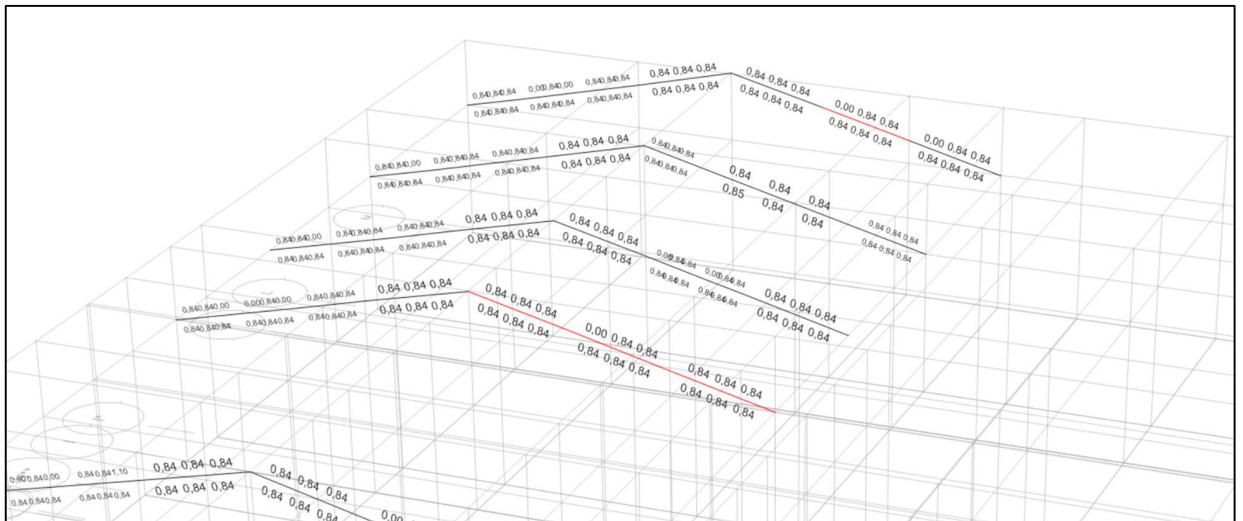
Secciones de vigas de cubierta (V1\_12CMX25CM). Sector entre ejes I-M y I-5.
